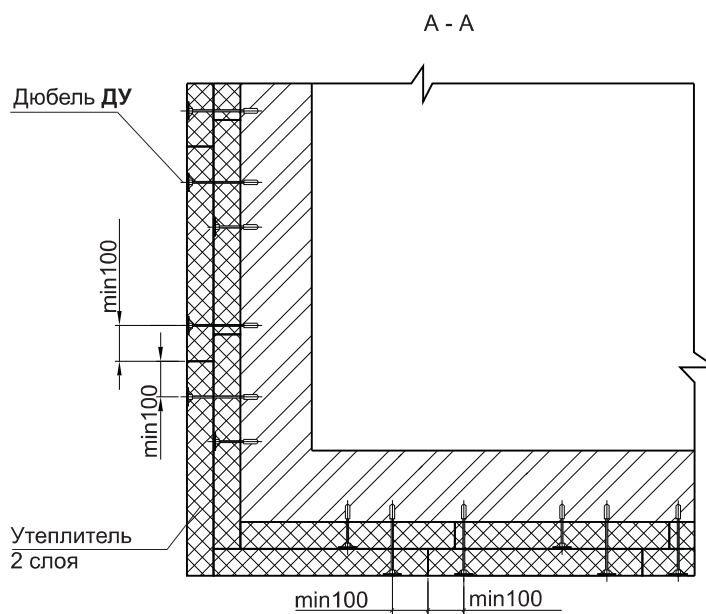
Схема крепления утеплителя на углу здания (разрез А - А).
